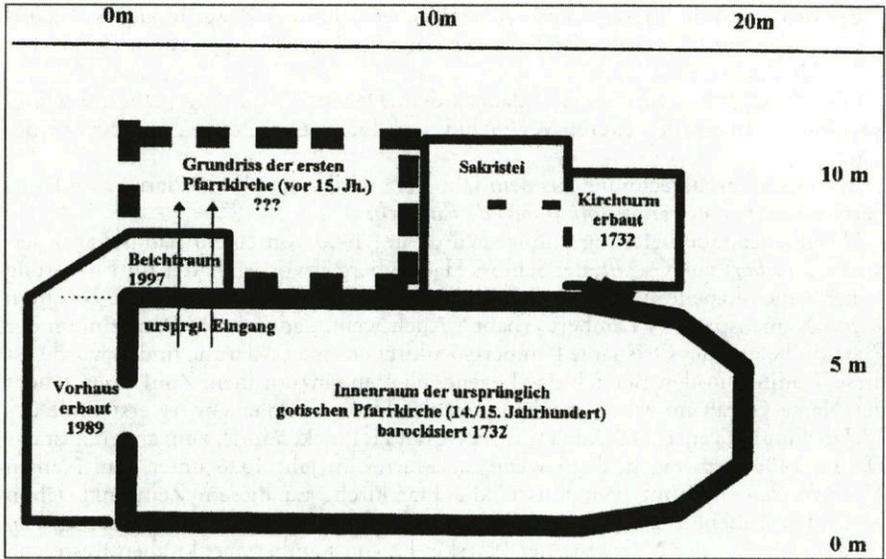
Grundrisszeichnungen zur baulichen Entwicklung von Pfarrkirche und Nebengebäuden
